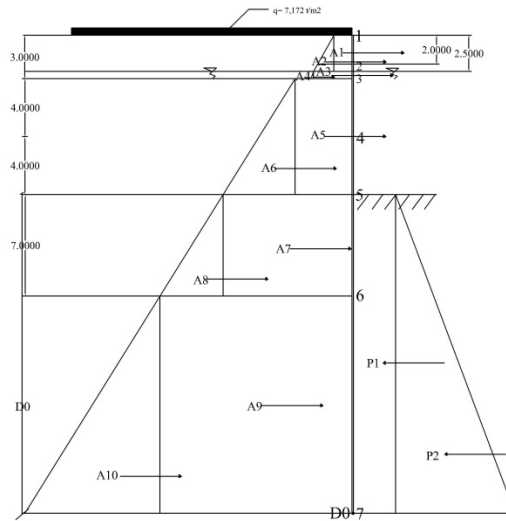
Sketsa tanah pada pemasangan *sheet pile* (dimensi dalam satuan meter)
